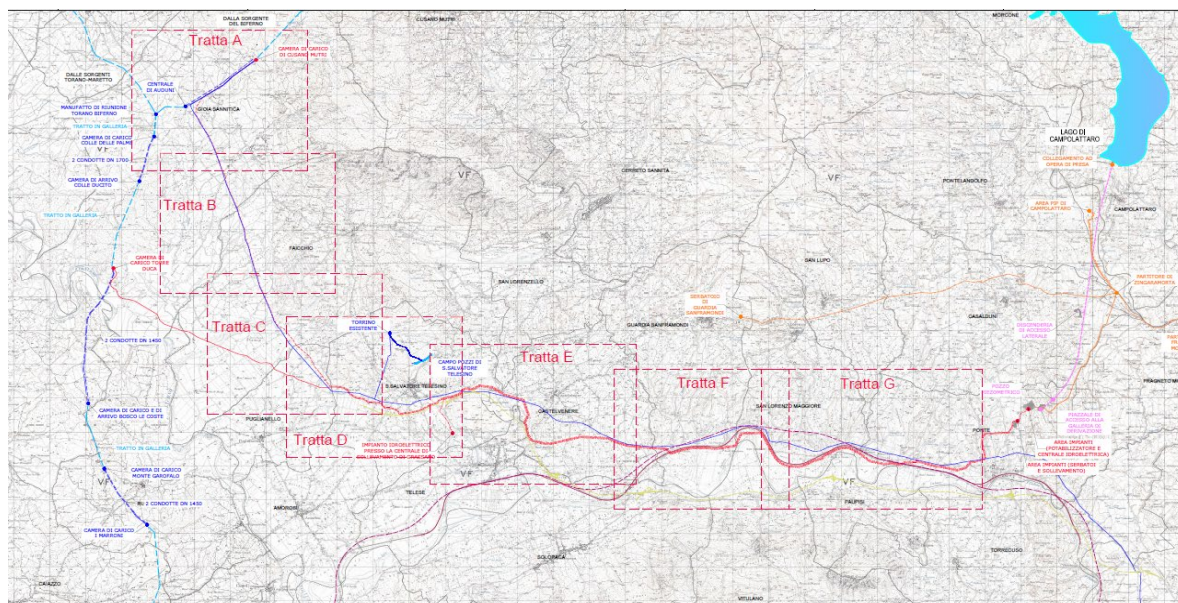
Planimetria della nuova condotta Curti-Benevento
